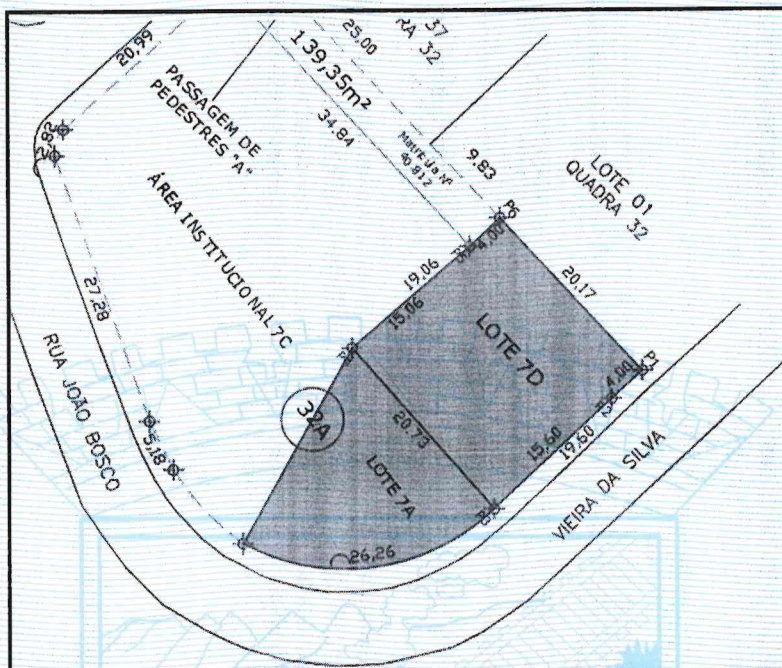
Planta dos lotes 7A e 7D da quadra 32A do Bairro Santa Rosa.
